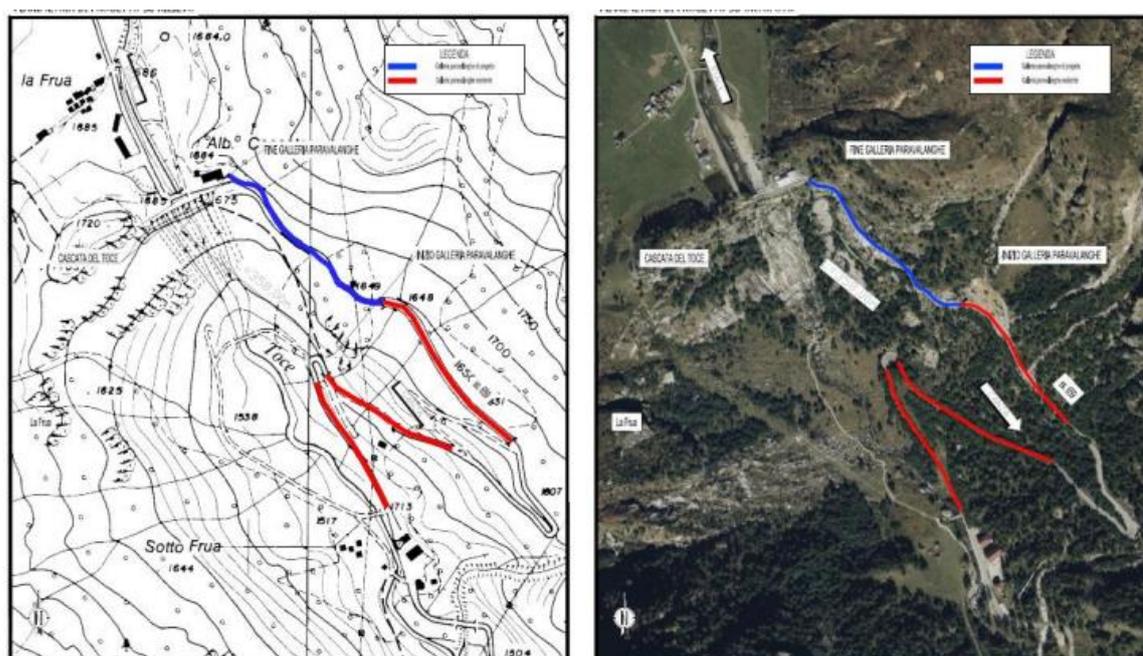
Planimetria di progetto (Fonte: Lista di Controllo)
